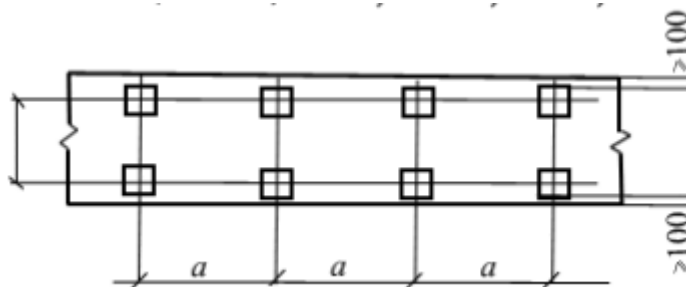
Схема расположения свай в рядовом фундаменте
